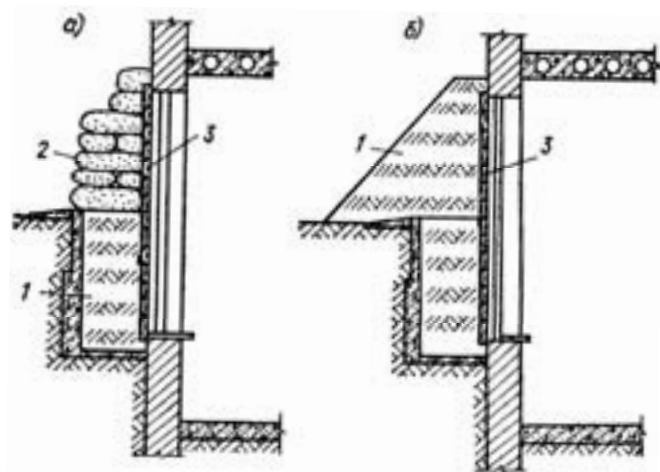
Підвищення захисних властивостей зовнішніх стін у місцях розташування віконних прорізів: а) мішками з ґрунтом; б) ґрунтом; 1 – ґрунт; 2 – мішки з ґрунтом; 3 – дерев'яний щит, який перекриває вікно.
